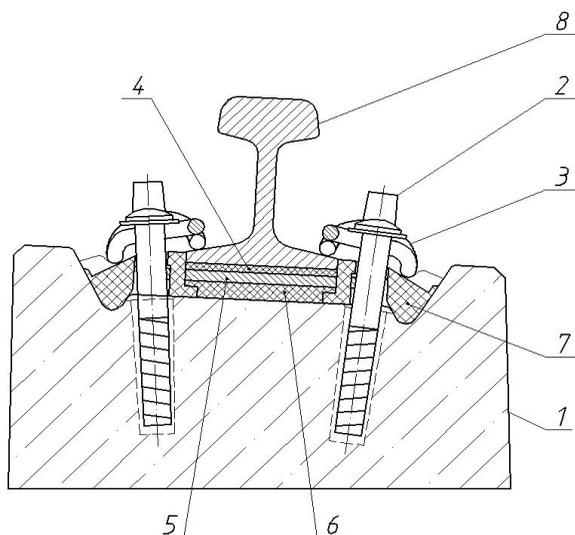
Блок опорный железобетонный с рельсовым креплением Vossloh 300 UTS:
